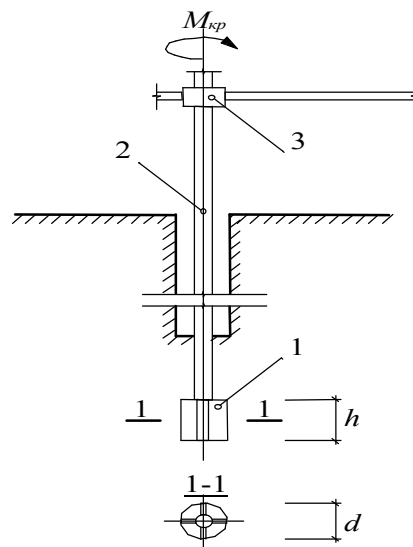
Схема приладу для випробування ґрунту на обертальний зріз: 1 – крильчатка; 2 – штанга; 3 – динамометрична рукоятка
